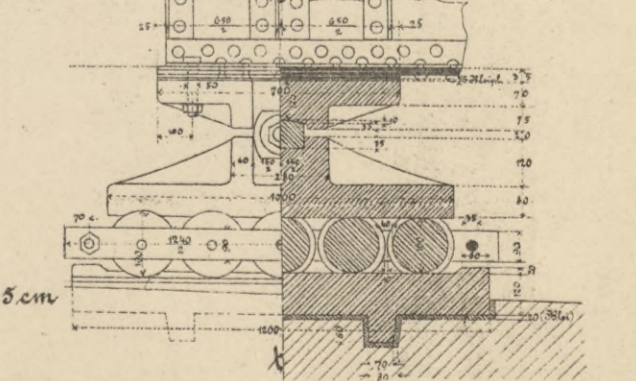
Bewegliches Lager auf den Widerlagern.
